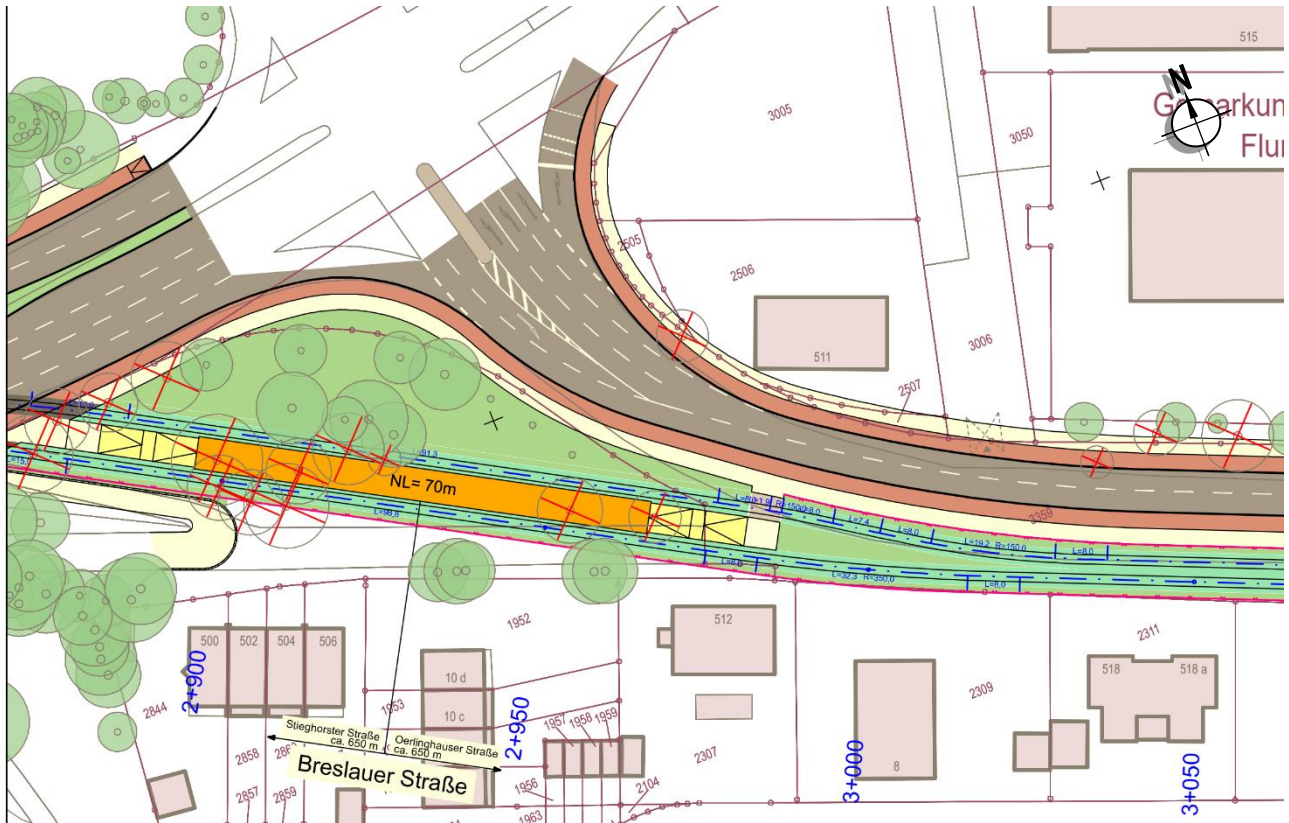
Trassenvariante 1 – Lageplan Haltestelle Breslauer Straße
